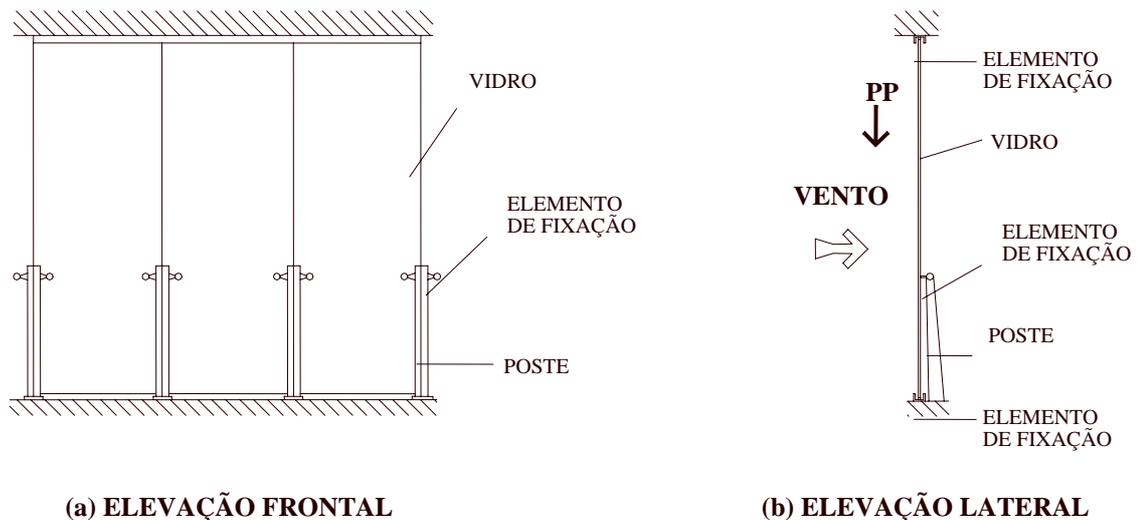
Esquema para painel de vidro com poste baixo reforçado.
